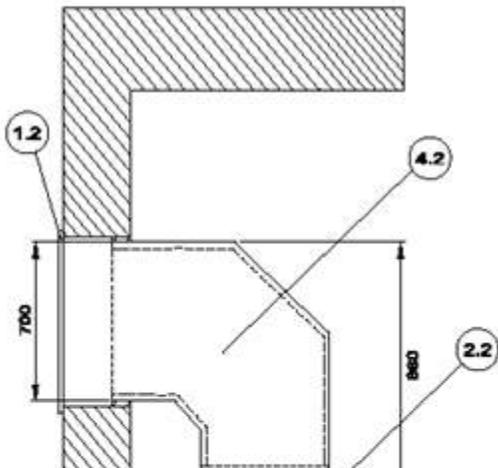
Vista dall'alto - LI 11TES (Installazione a parete con canale aria lato mandata)
